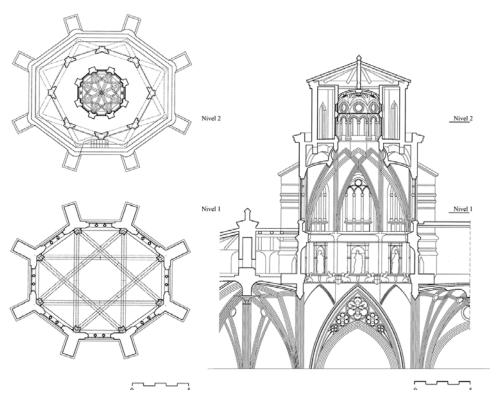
Planta y sección del cimborrio (dibujo de Francisco Fes)
